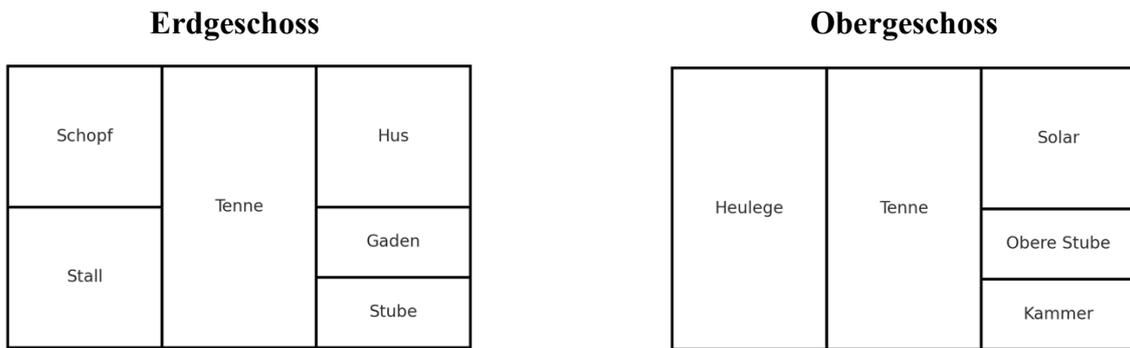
Schematischer Grundriss eines Allgäuer Bauernhauses, verändert nach Kettemann, 2000
